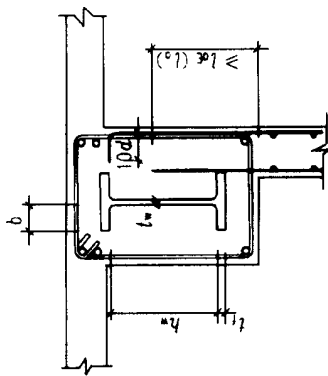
钢筋混凝土墙、梁与钢骨混凝土柱的连接构造
